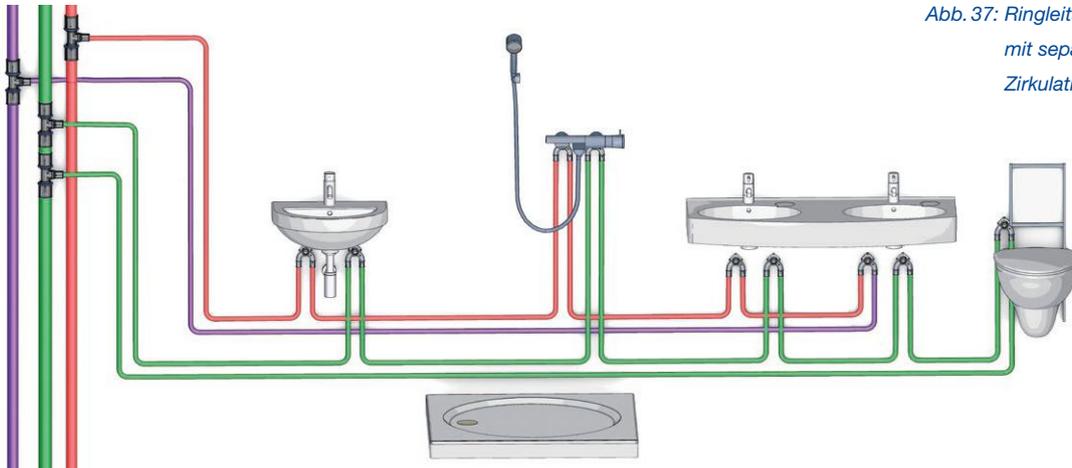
Ringleitungsinstallation mit separater Zirkulationsanschluss
